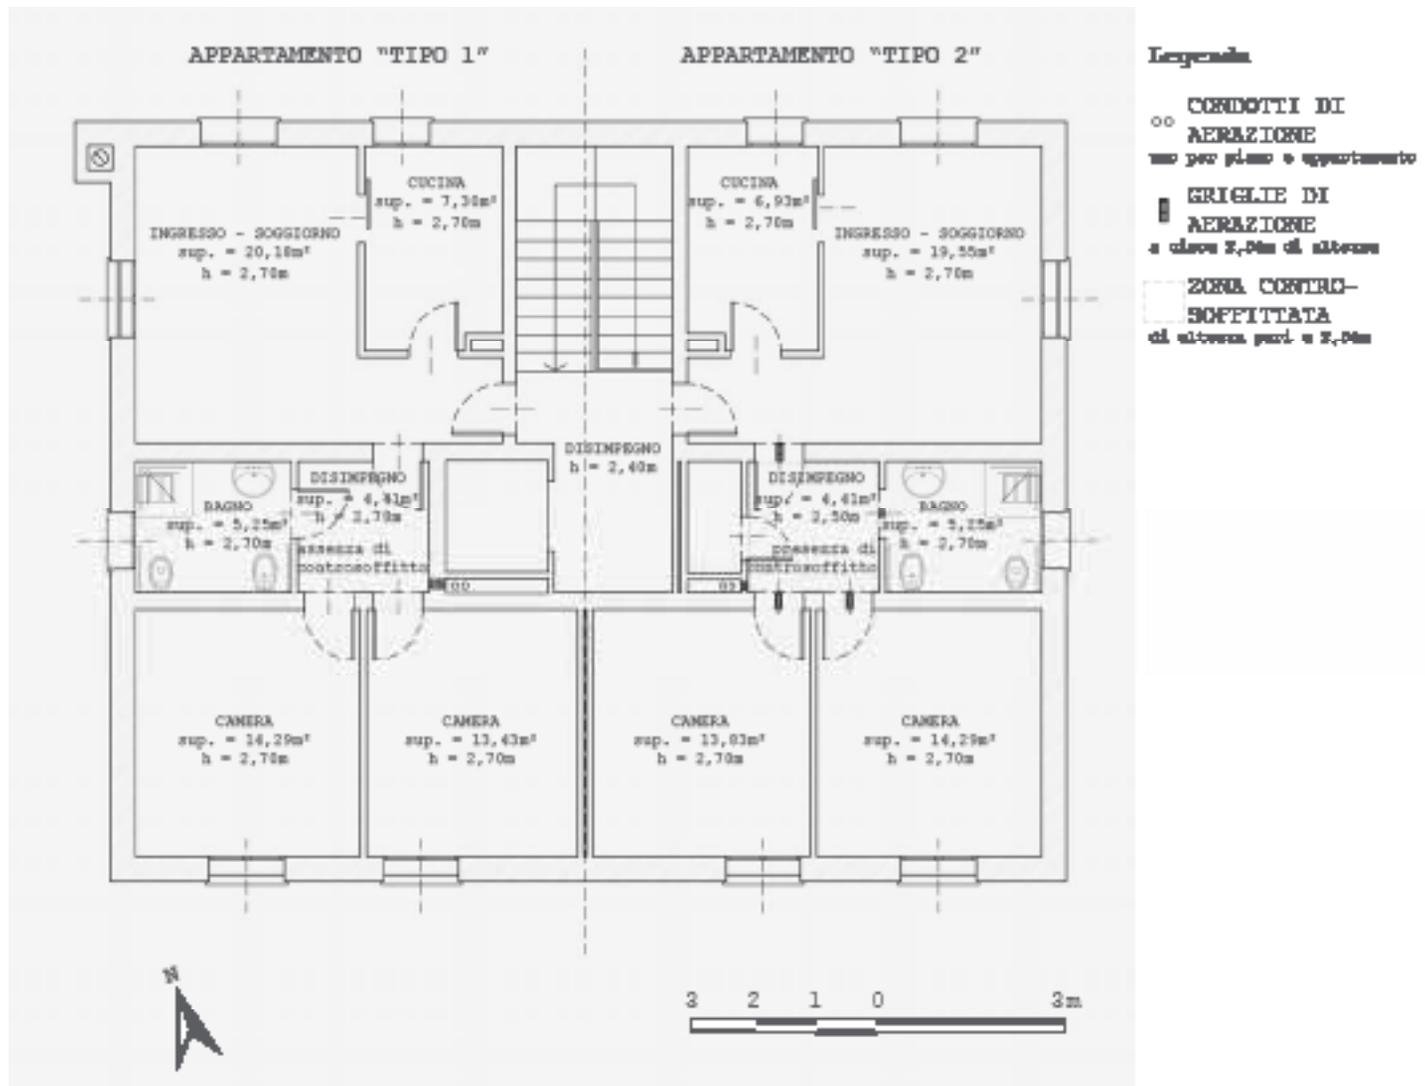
Sistema passivo ibrido per al ventilazione naturale - planimetria piano tipo.
